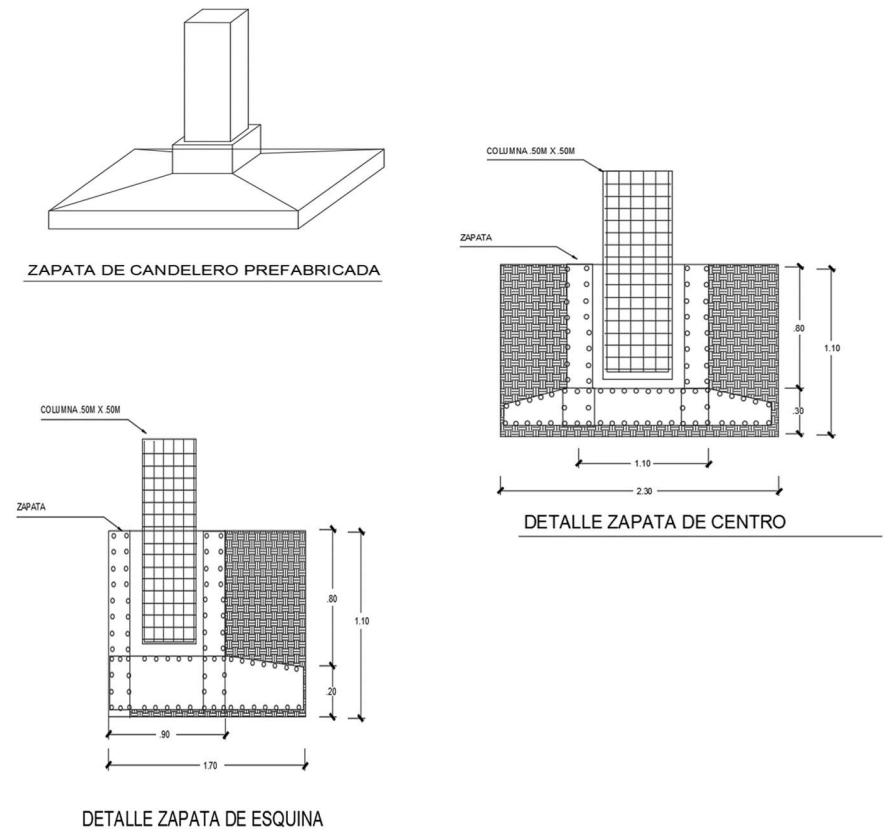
, 92 y 93: Detalles de zapatas para edificio de administración.
